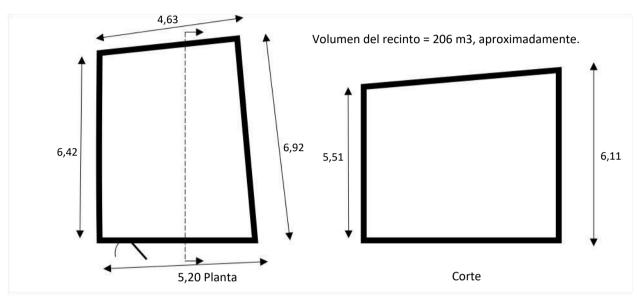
Esquema de planta y corte de los recintos de ensayo
